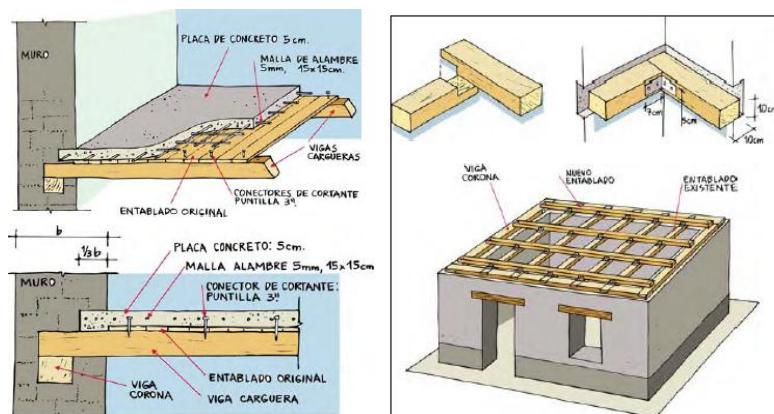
y 29: Esquema sobre la construcción de una edificación en tapia pisada.
